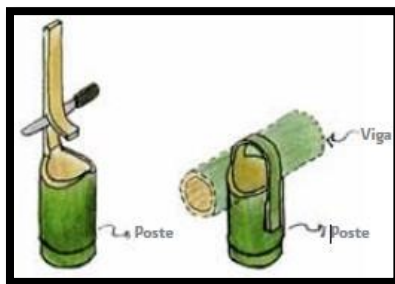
Intersección de viga y columna con tiras propias del culmo columna
